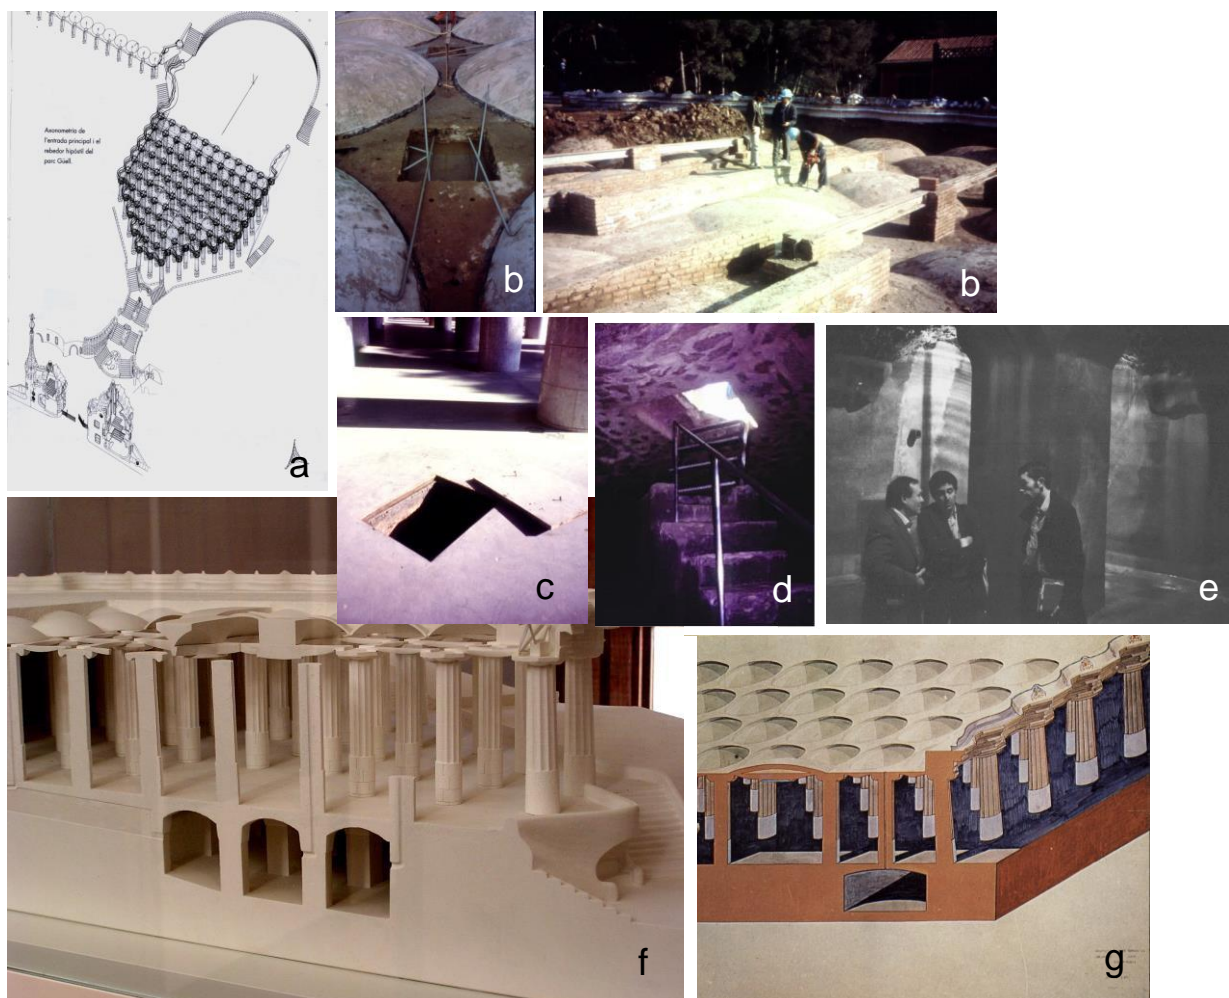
Sistema plaza/columnata/cisterna: a) conjunto de captación y conducción (dibujo de Hiroya Tanaka); b) elementos de la captación en el subsuelo de la plaza (fotos de la restauración de 1990 – fuente: Cátedra Gaudí); c) trampilla de acceso a la cisterna (foto C. da Silva, 2002); d) escalera de acceso a la cisterna (foto C. da Silva, 2002); e) interior de la cisterna (foto Kim Arcas, 2005); f) maqueta del sistema, visible el ramal subterráneo a la izquierda de la cisterna (fuente: ETSAV/UPC); g) perspectiva (fragmento), enseñando columna hueca que desagua en el ramal subterráneo (fuente S. Tarragó).
